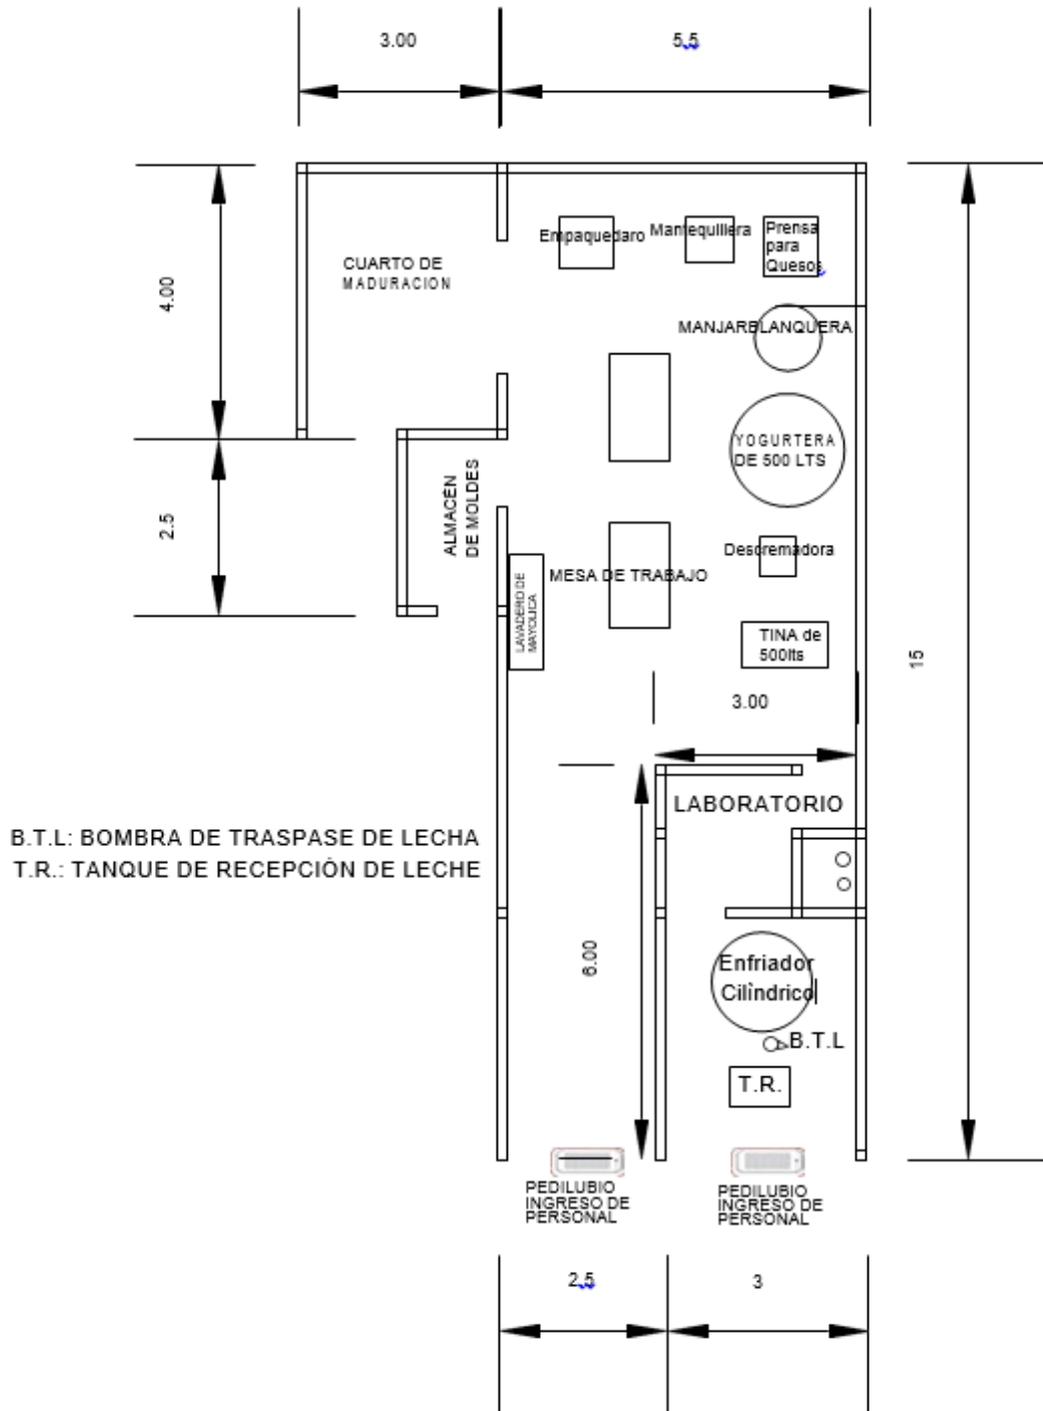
Diseño de distribución de planta para la planta procesadora de lácteos del distrito de Levanto.
